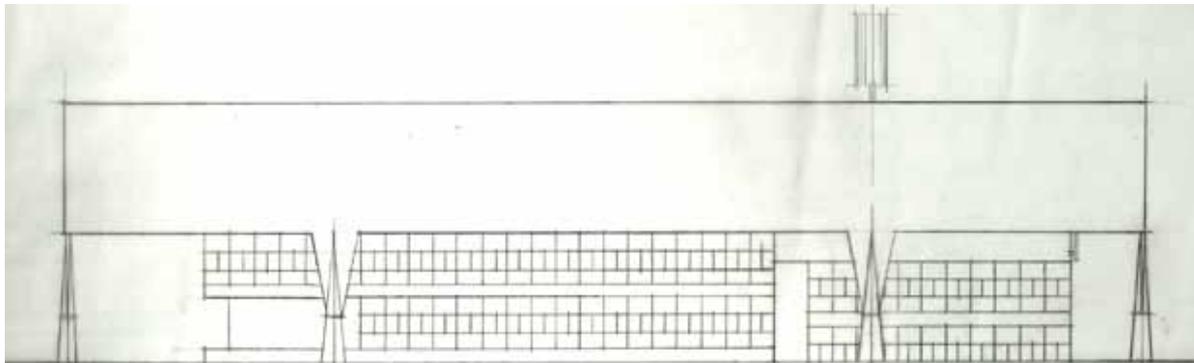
Elevação lateral leste do prédio da FAU-USP, projeto Vilanova Artigas, desenho a lápis do autor, original em escala 1:200.
